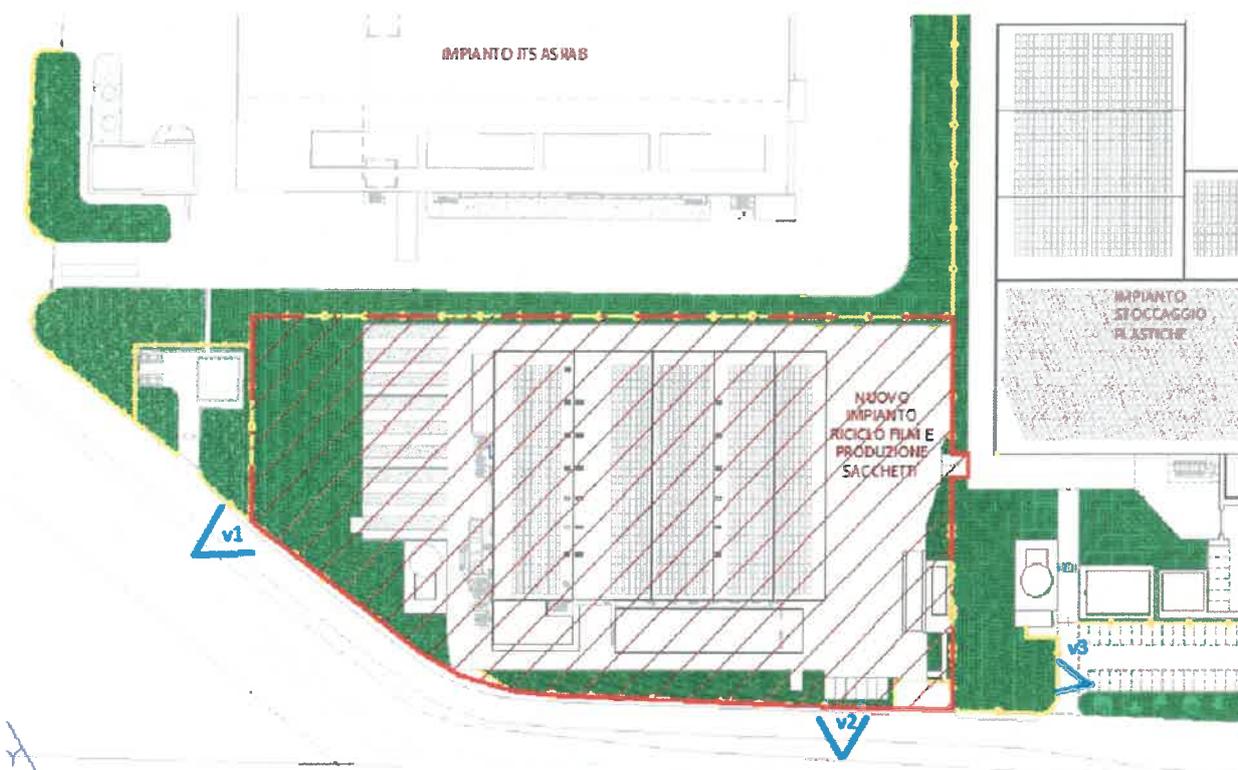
Pianta chiave documentazione fotografica dell'area d'intervento
